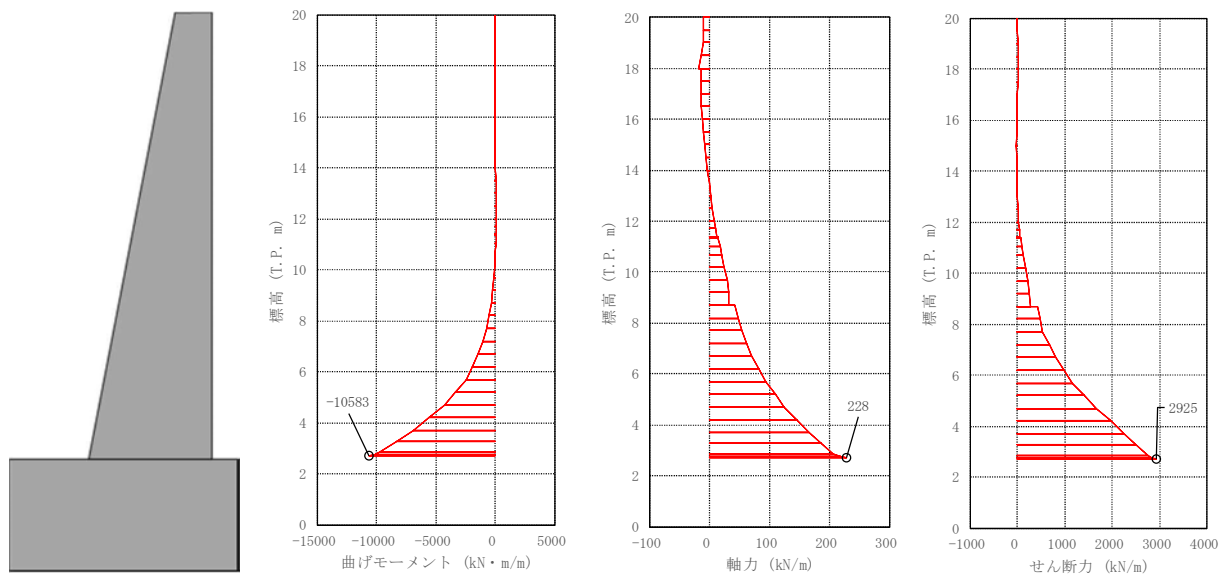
(1) 鉄筋コンクリート防潮壁においてコンクリートの照査結果が最も厳しい断面力
